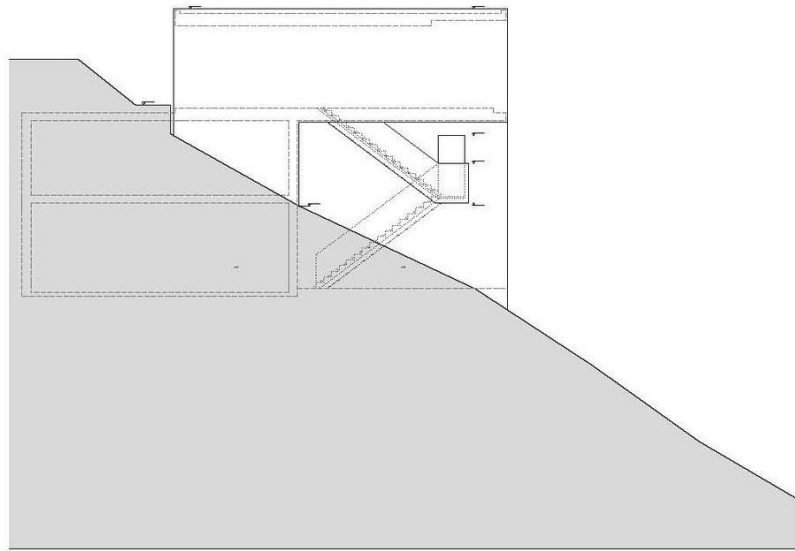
Alzado noreste. Fuente: Fran Silvestre Arquitectos.
